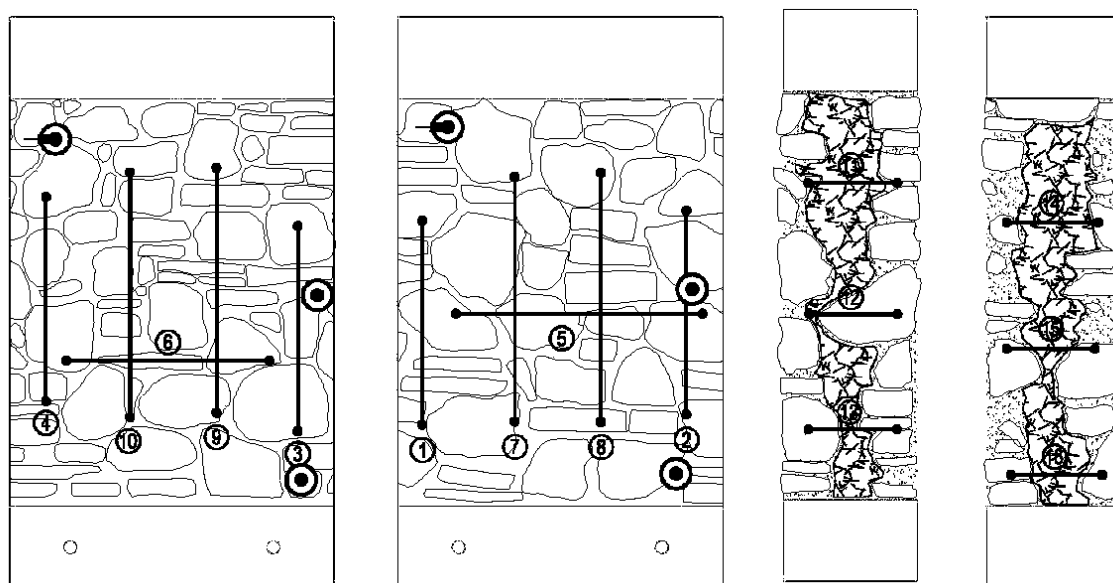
Disposizione dei trasduttori di spostamento nelle prove di compressione diretta (Santunione e Secchiero, 2011).
